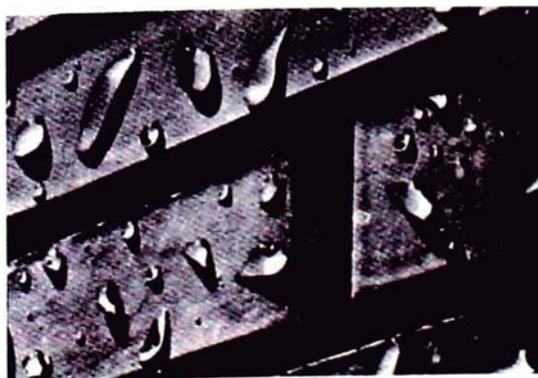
Detalle de una pared de ladrillo visto, impermeabilizada con Repulso de Halesa.
